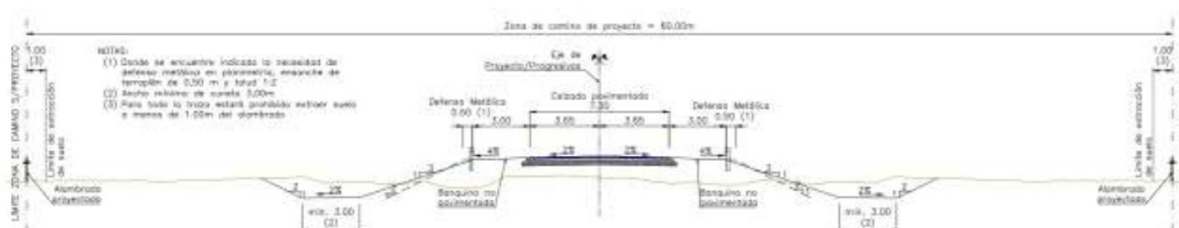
Perfil Tipo 1 – Rama Sur – Pr. 20+000 a 21+660
